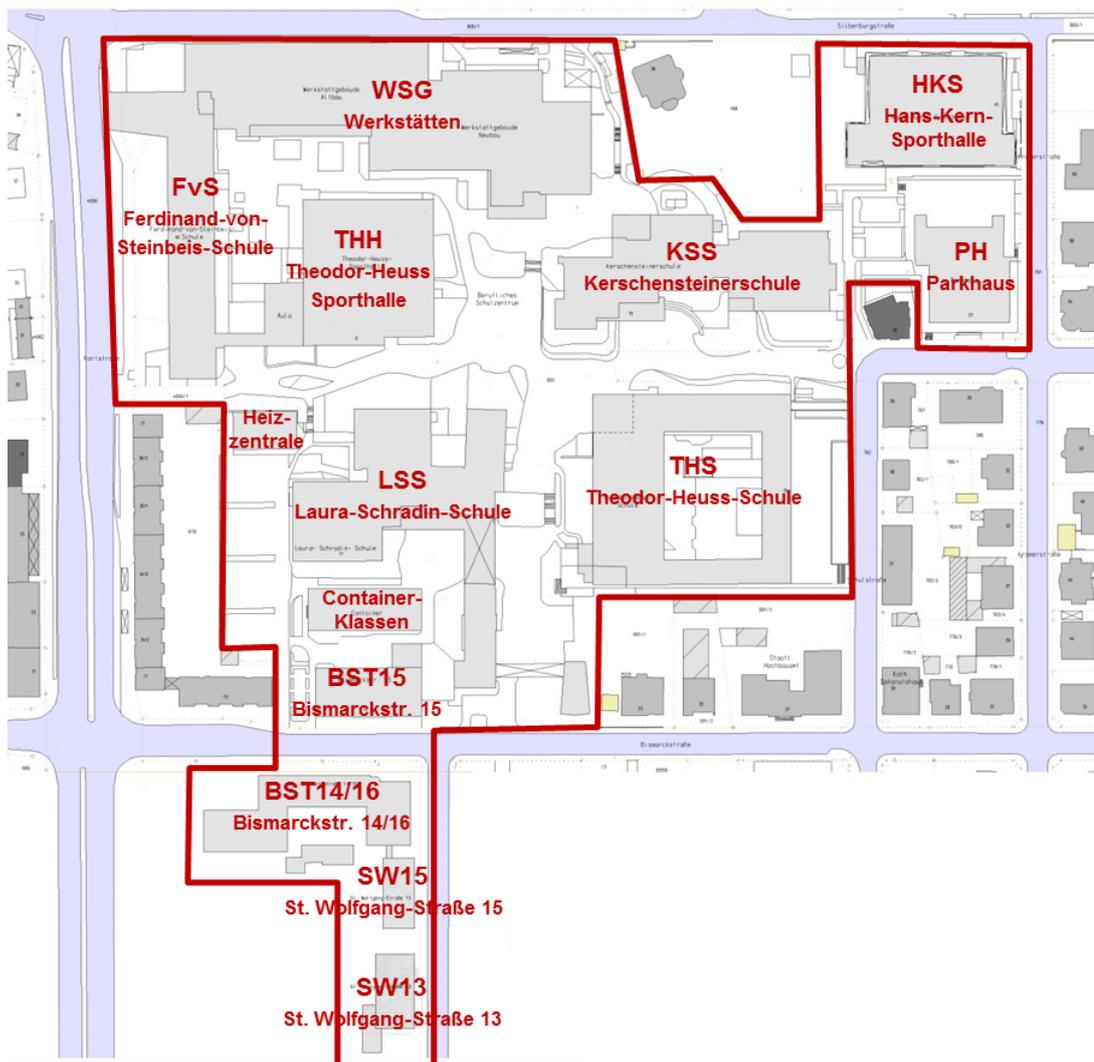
Lageplan des Untersuchungsgebiets mit Bestandsgebäuden
